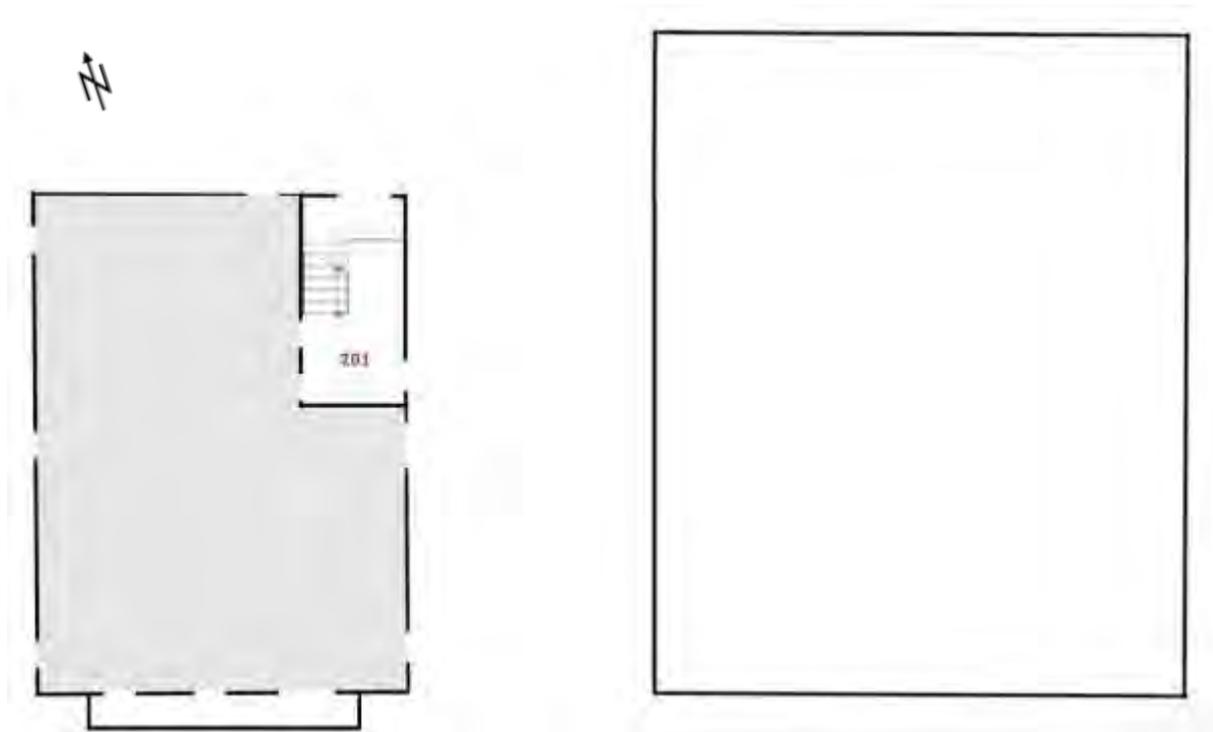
Schematischer Grundriss 2. Obergeschoss. Bearbeitung IBID.
